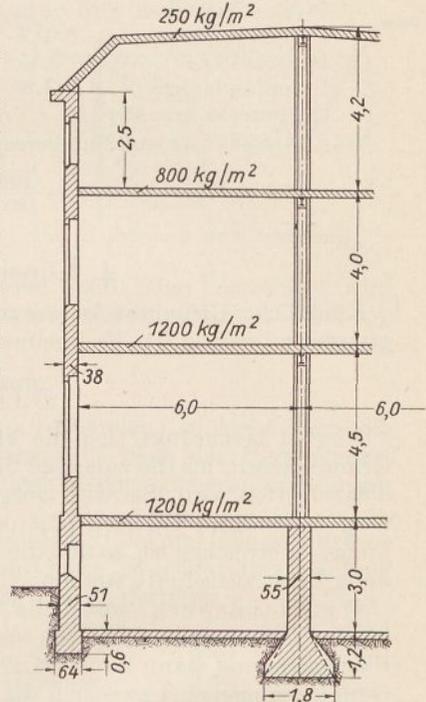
Kleines Fabrikhaus als Geschoßbau.
